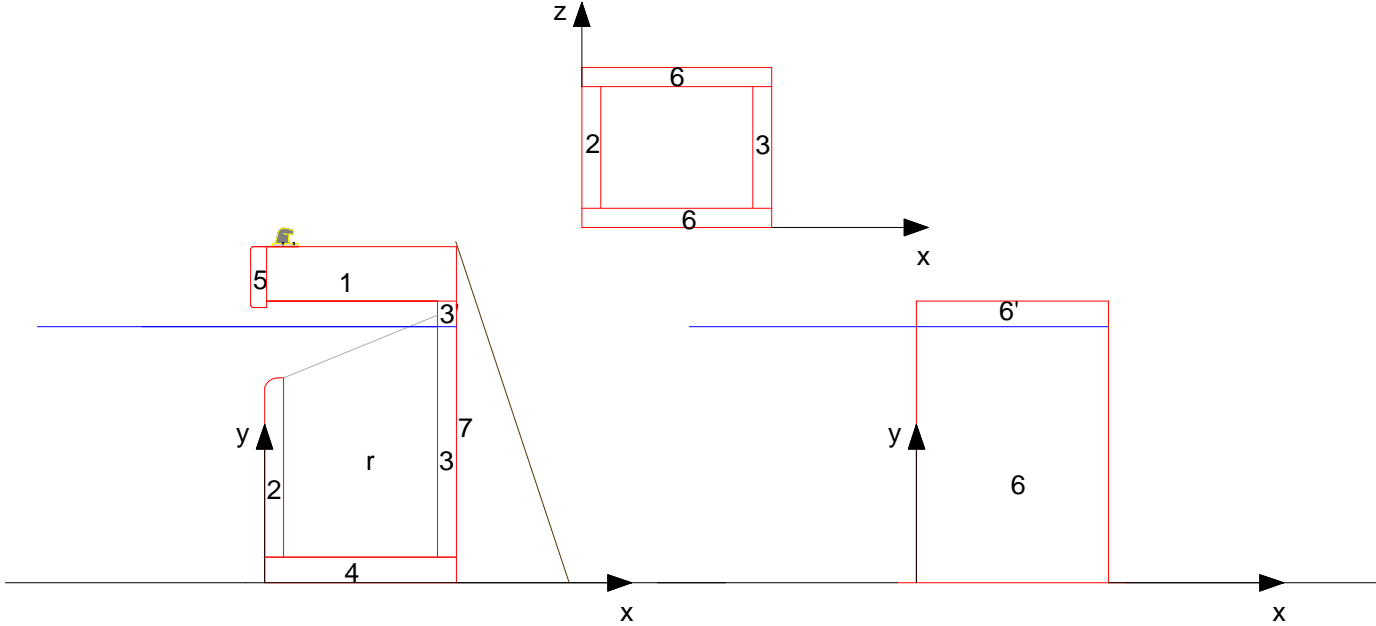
FIG I- Schema di calcolo per il cassone Pianta e sezioni
